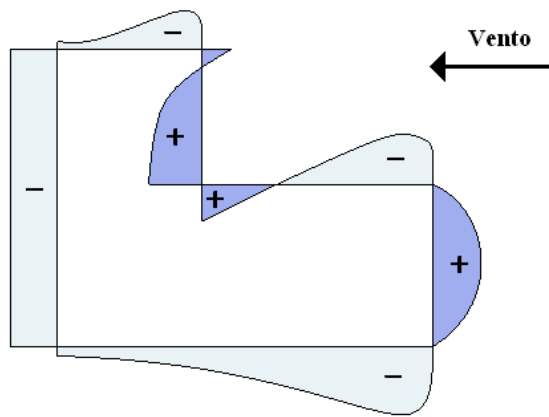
Distribuição de pressões nas fachadas de um edifício de planta em L (vista em planta) [6]
